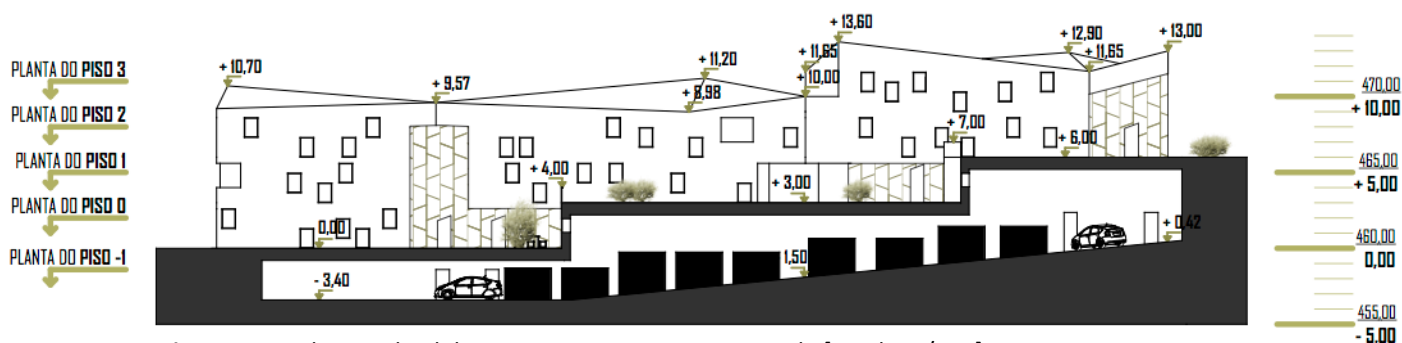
Corte longitudinal da proposta – Garagem rampeada [Escala: 1/500]
